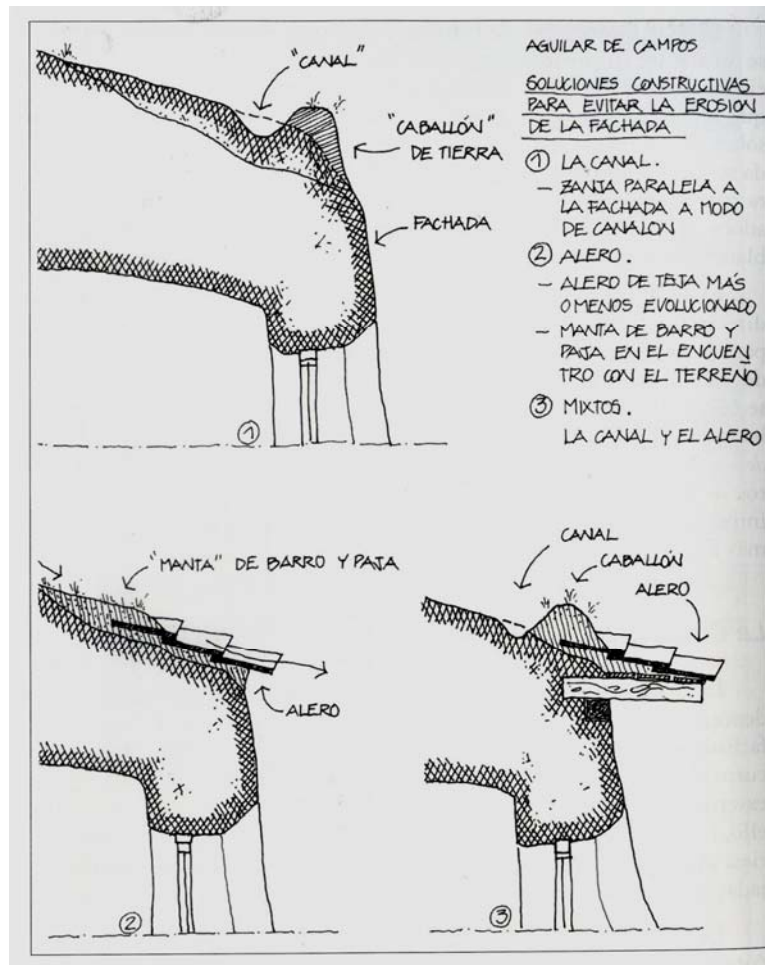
Esquema de la protección de fachada en Aguilar de Campos (Jové, 2006).
